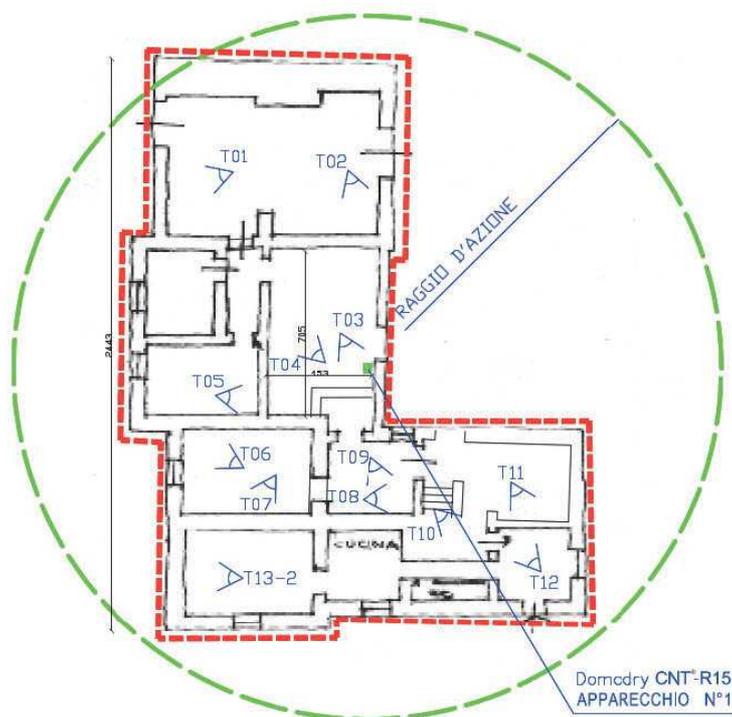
Schema planimetrico del dispositivo CNT installato nel maggio 2013
